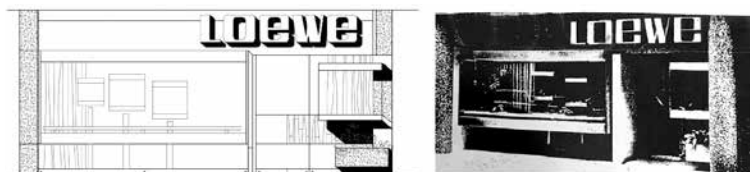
Fachada de la tienda de Loewe en Jermyn St. Plano elaboración propia. Imagen publicada en el periódico ABC el 12/11/1966. Plano del proyecto de instalación de la tienda de Londres de Javier Carvajal para Loewe, abril 1966. Archivo General de la Universidad de Navarra / Fondo Javier Carvajal Ferrer / Proyecto de instalación de Tienda para Loewe en Jermyn St.
